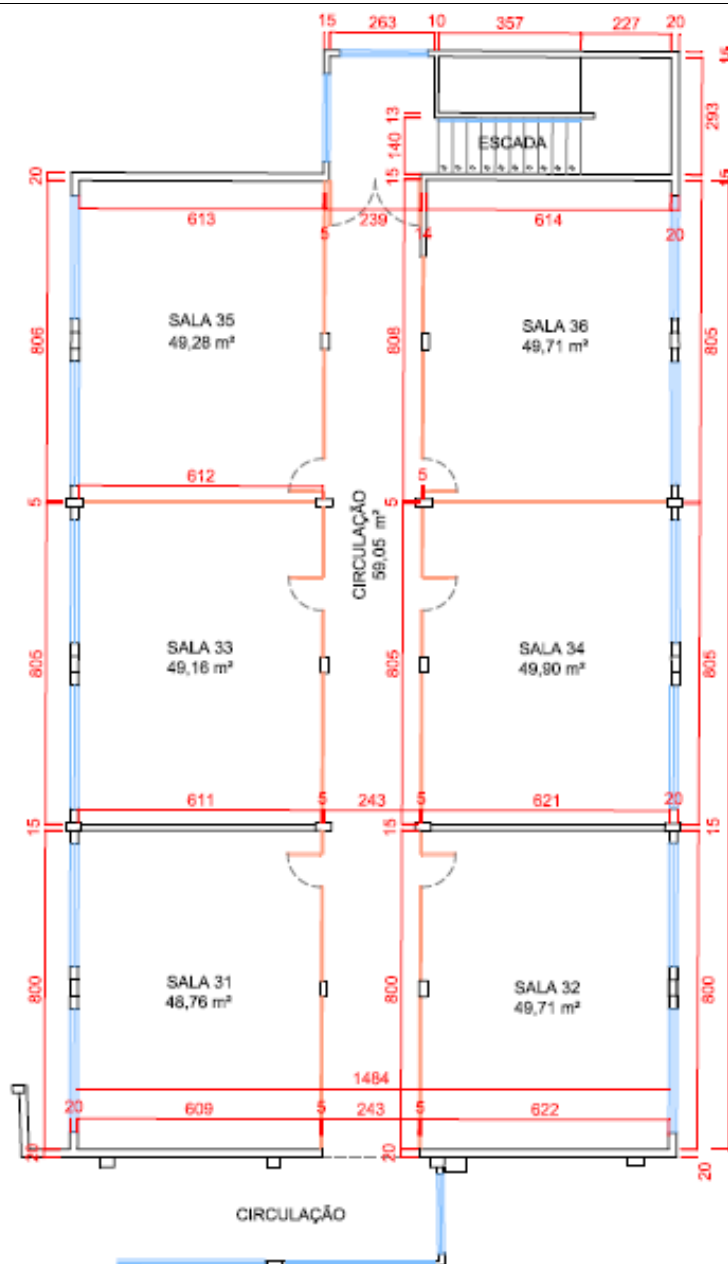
Planta Baixa do terceiro pavimento com salas de aula, no bloco da Biblioteca
